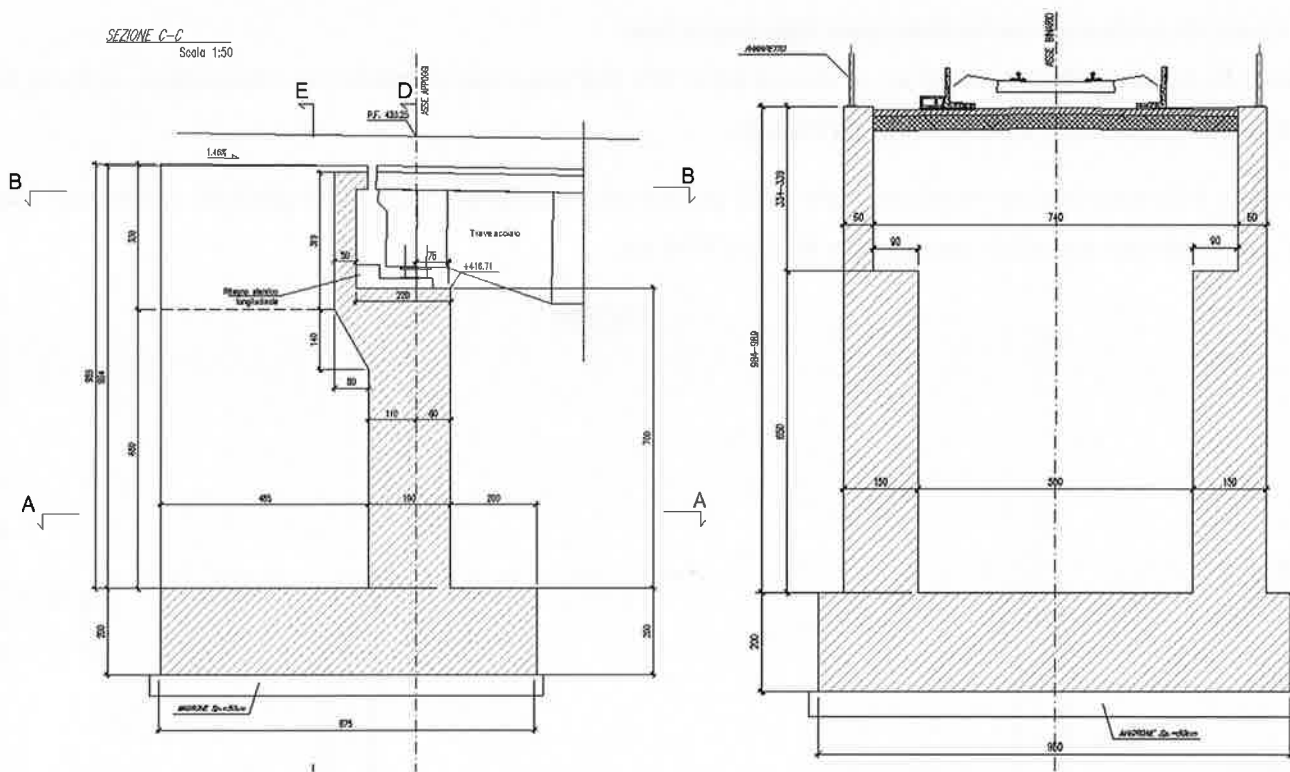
Sezione longitudinale e trasversale spalle, Bonorva VI02
